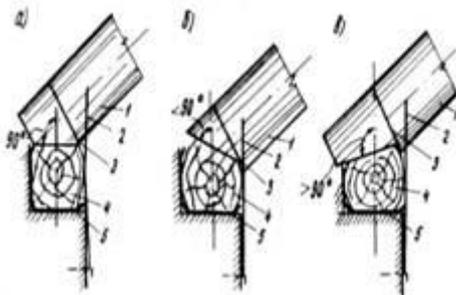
Правильное (а) и неправильное (б) и (в) выполнение опирания наклонной стропильной ноги на мауэрлат:
